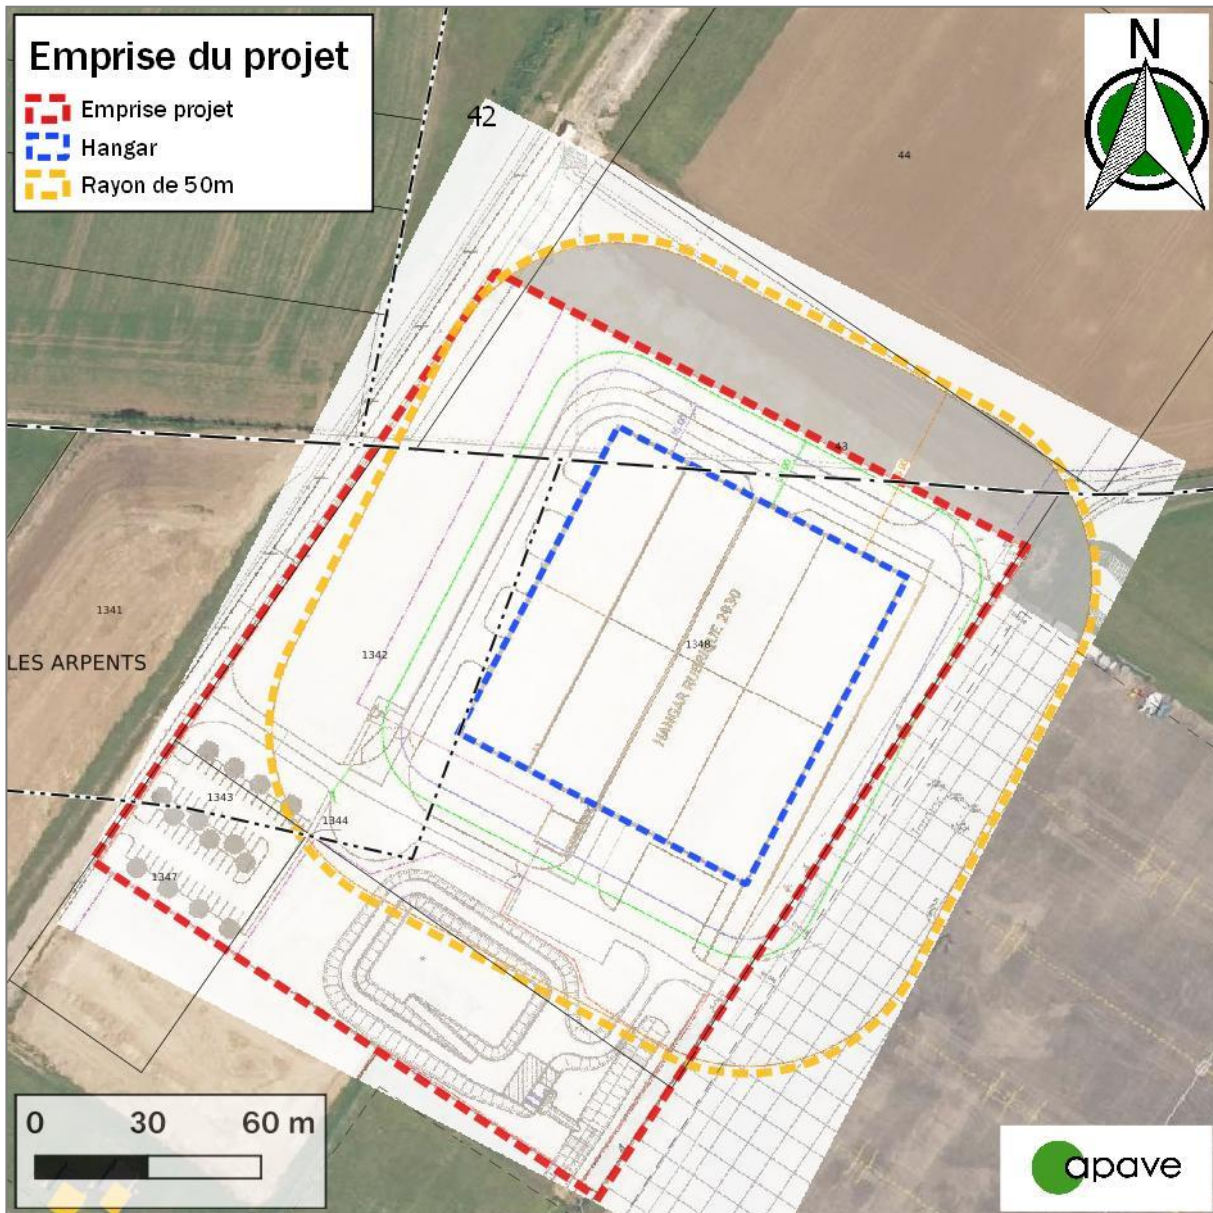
Plan de superposition du plan projet avec l'emprise projet sur plan cadastral et photographie aérienne (source : APAVE et Géoportail pour la cartographie)
